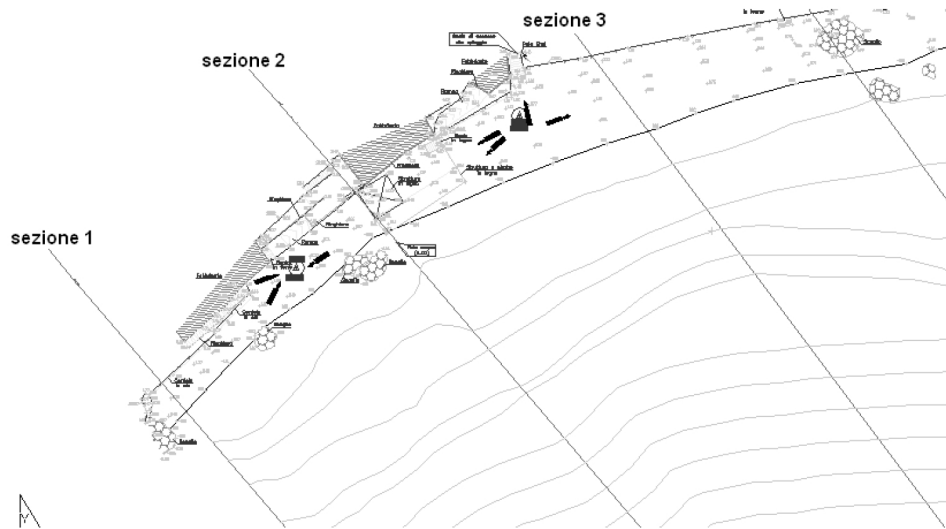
Planimetria della Spiaggia dei Tedeschi (Est)
